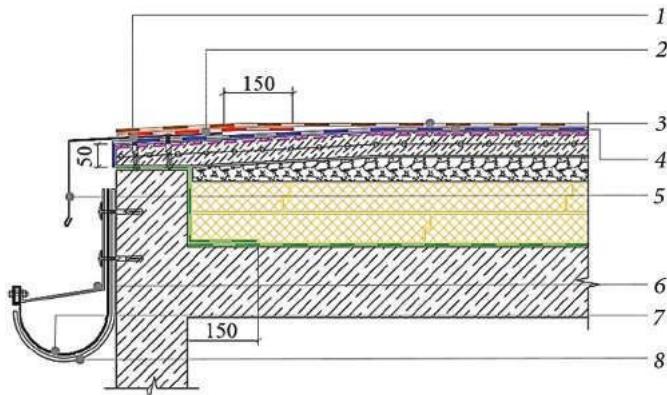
Наружный водосток: 1 — верхний слой кровельного покрытия; 2 — нижний слой кровельного покрытия; 3 — слой усиления из кровельного материала; 4 — крепление саморезами в шахматном порядке; 5 — отлив из оцинкованной стали; 6 — крепежный элемент с шагом от 300 до 900 мм; 7 — водосточный желоб; 8 — крепежный элемент с шагом от 300 до 900 мм
